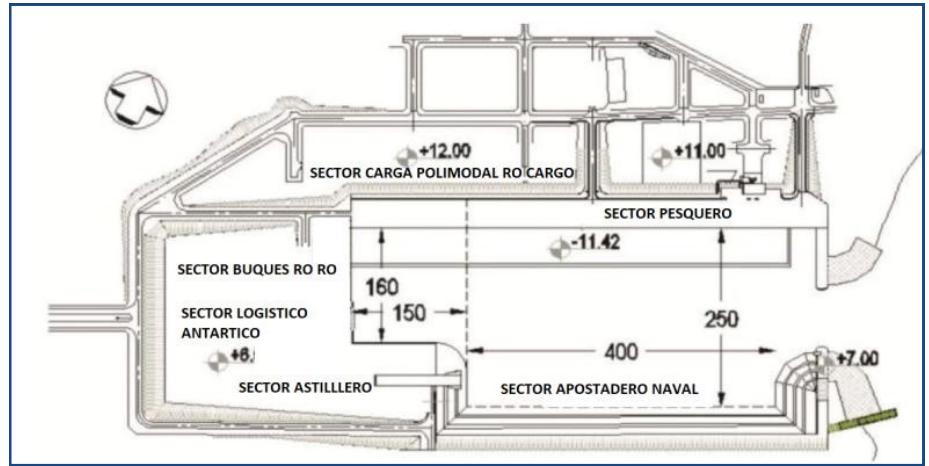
Plano de proyección de un puerto excavado en Río Grande
